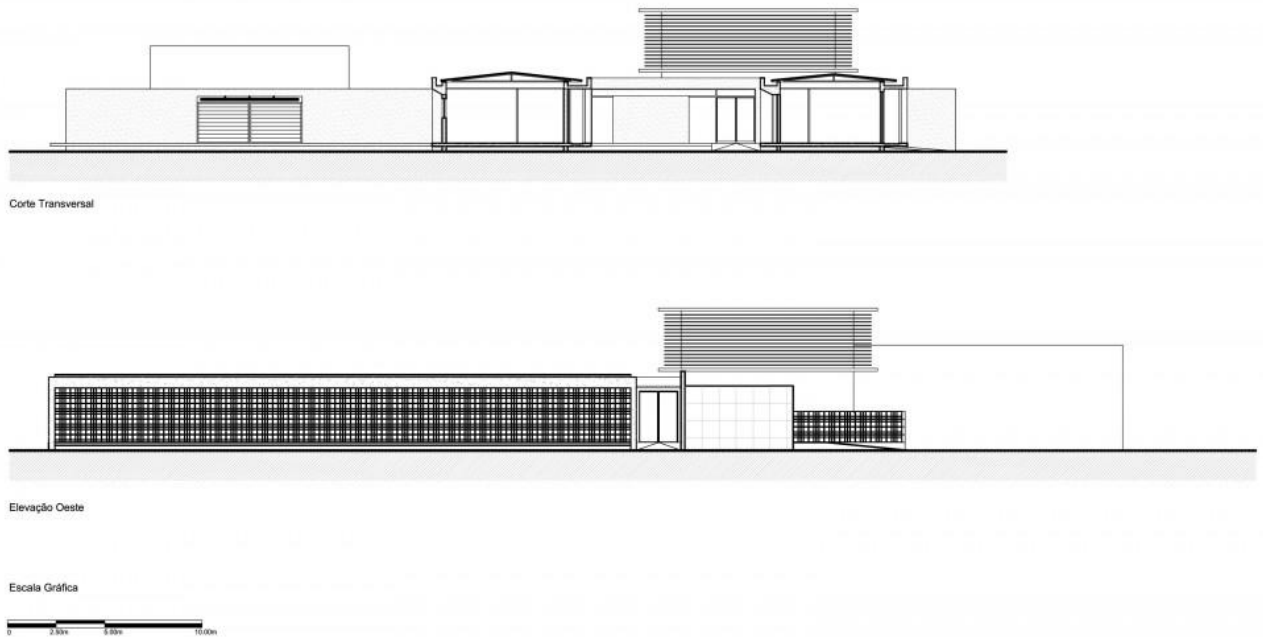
Corte transversal do edifício e elevação oeste
